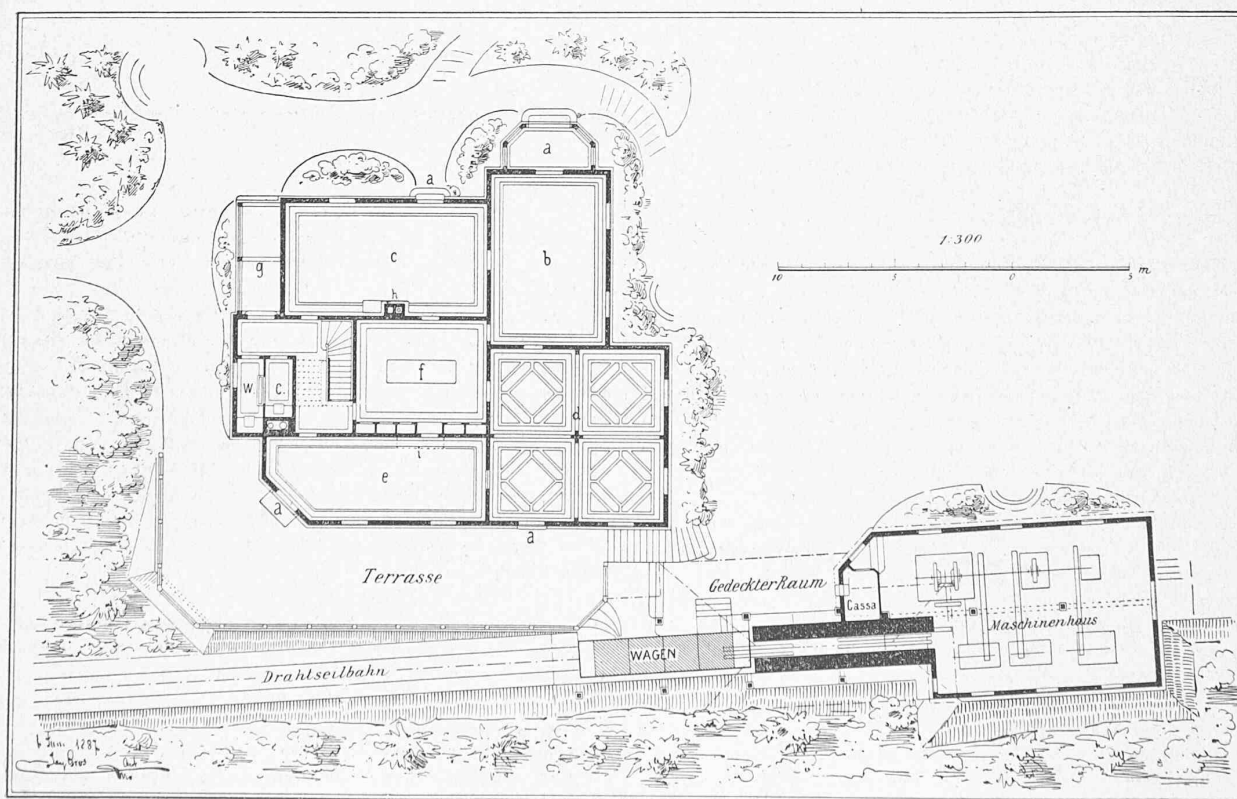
Grundriss vom Erdgeschoss.
